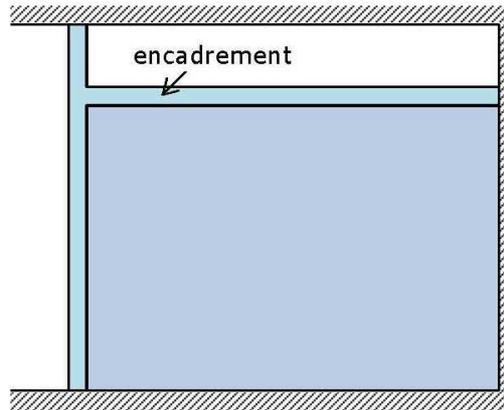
Encadrement des cloisons n'atteignant pas le plafond
